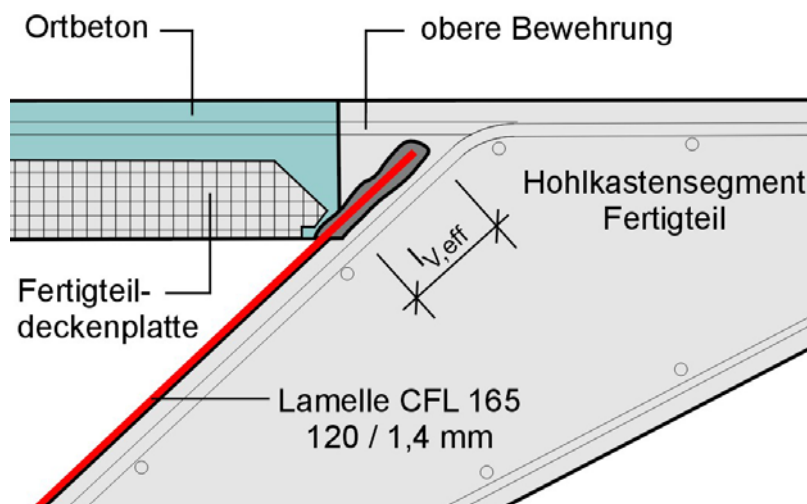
Detailausbildung des oberen Anschlusspunktes (Detail a)
